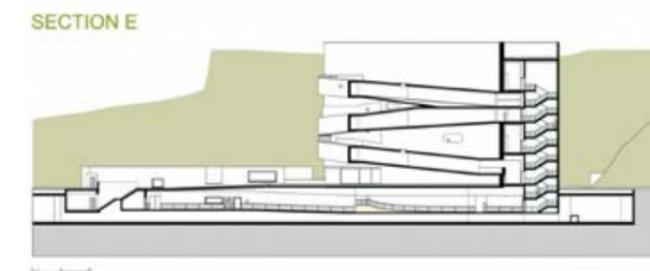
Fundação Iberê Camargo, 2003, Álvaro Siza. Corte E. Fonte: Site Fundação Iberê Camargo, s/p.
